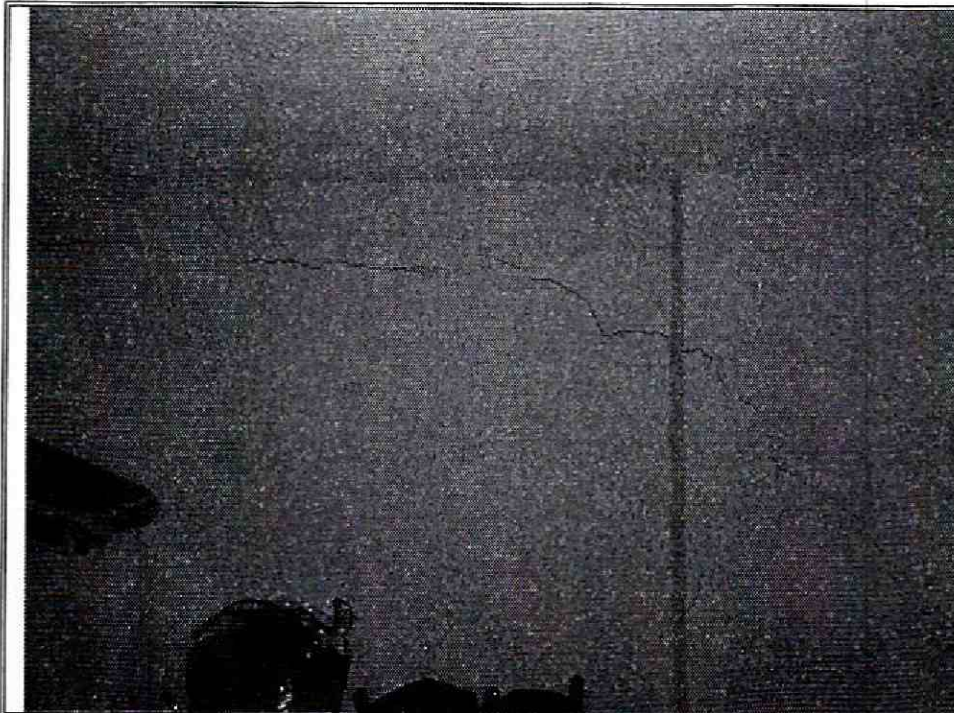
Fisuras en el muro sobre el costado occidental de la vivienda de la Calle 50 C Sur No. 12 C - 33.
